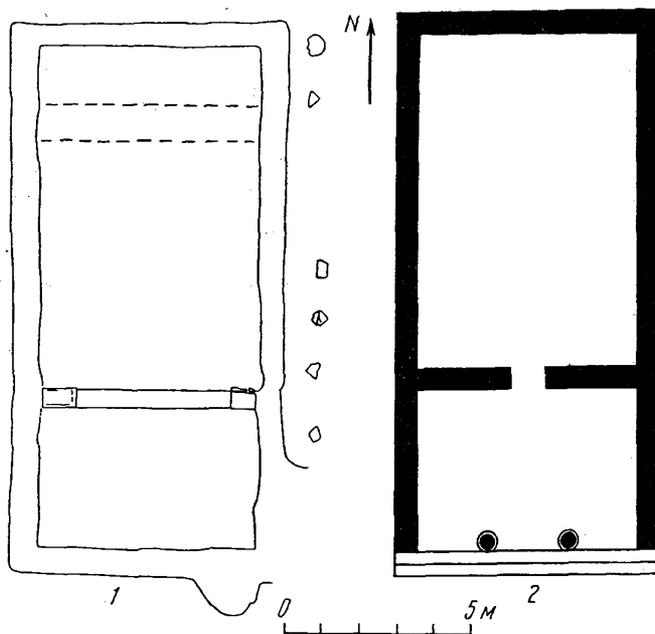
План храма Аполлона Врача. 1 – схема обмерного плана, 2 – реконструкция
